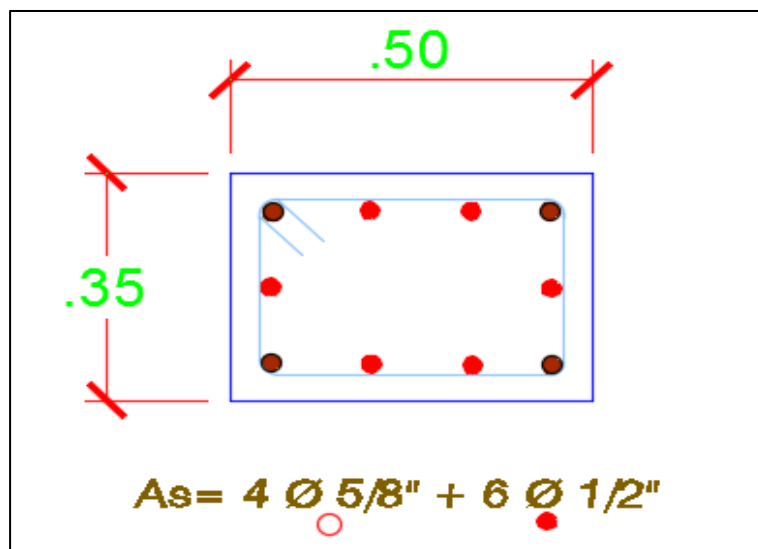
Sección Transversal Columna C-1 x-x. Fuente: Elaboración propia.
